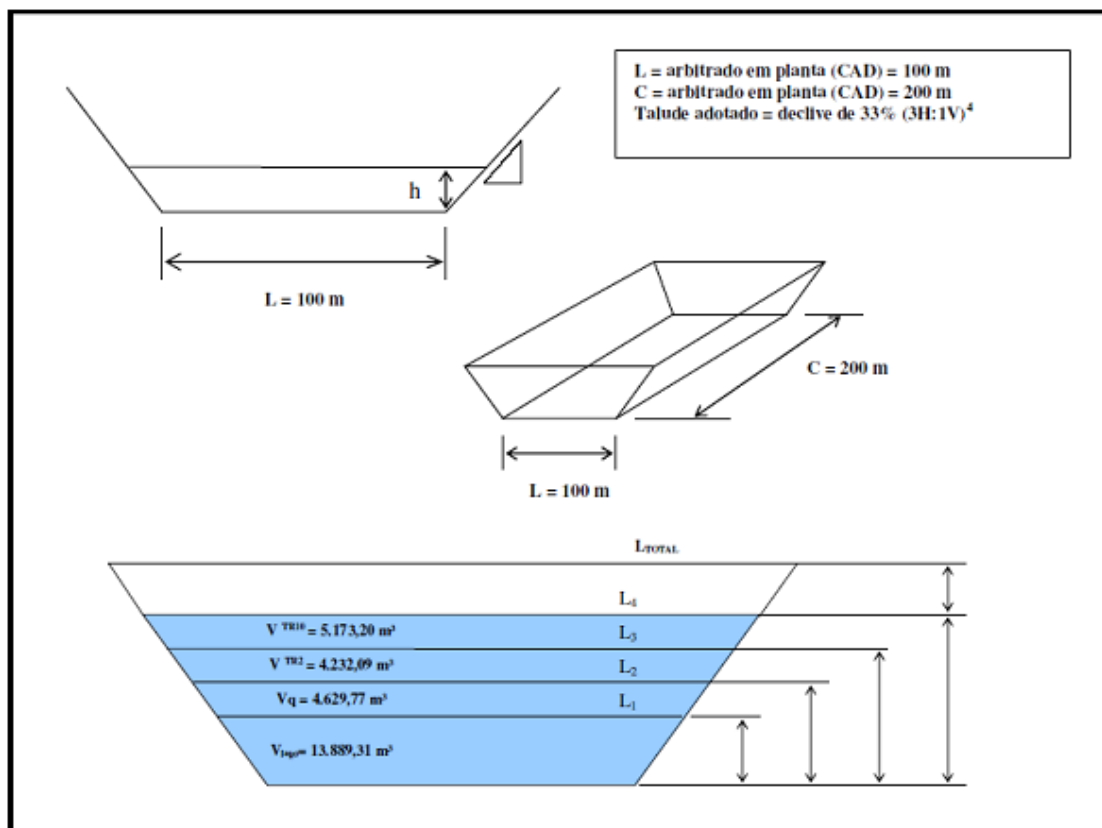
Desenhos esquemáticos das estruturas propostas – bacia de retenção
